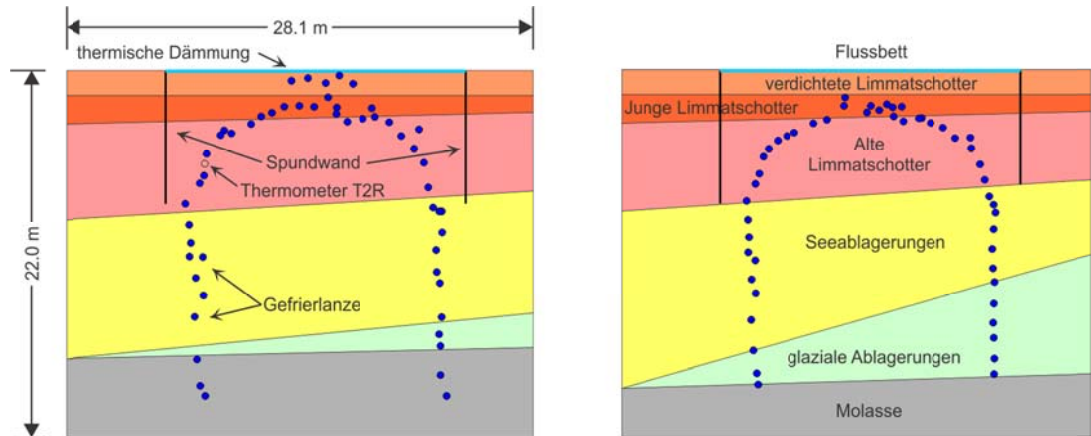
Schichtenabfolge und Ist-Lage der Gefrierlanzen des Querschnittes A-A (links) und des Querschnittes C-C (rechts)
